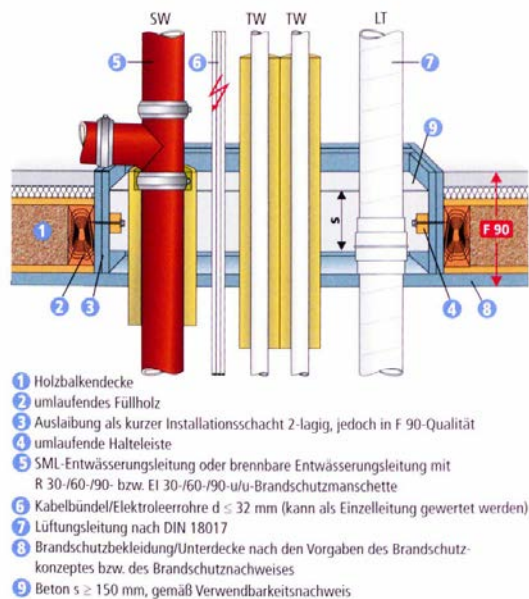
Beispiel von Leitungsabschottungen durch eine feuerbeständig ertüchtigte Holzbalkendecke mit Auslaibung und innenliegenden klassifizierten Abschottungen inkl. Halteleiste [178]
